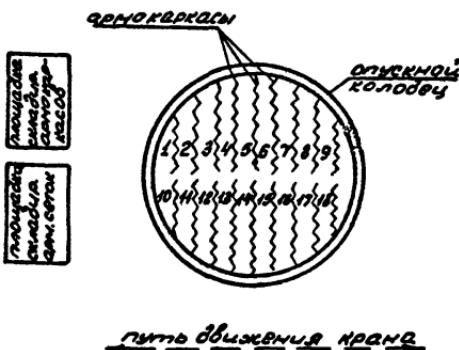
Схема последовательности установки арматурных каркасов I, 2, 3 и т.д. — порядковые номера установки арматурных каркасов
